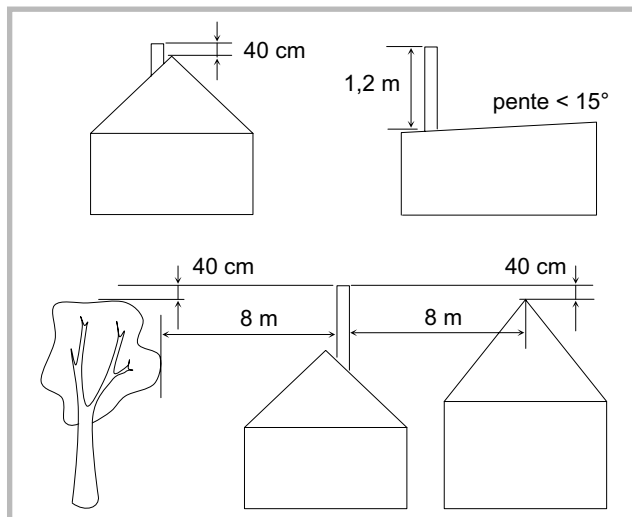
Hauteur de la souche du conduit d'évacuation (B23, B23P)
